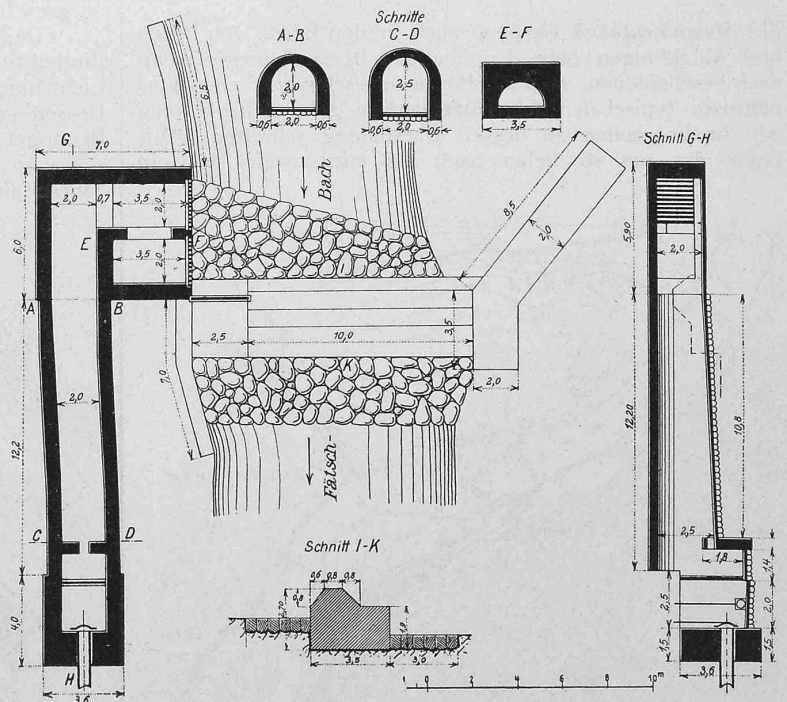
Die Wasserfassungsanlage. Grundriss und Schnitte. — Masstab 1 : 300.
